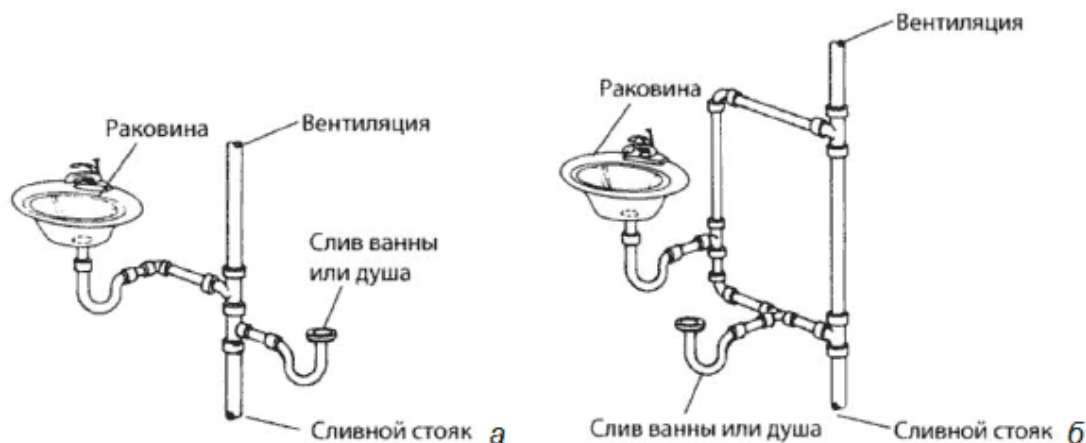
Многотрубные вентиляционные соединения. Прямые вентиляционные трубы подсоединяются напрямую к канализационному стояку и вентиляции (а). Деаэрация двух сливных труб, подсоединенных к стояку. Обратите внимание на кольцевое соединение труб, с помощью которого обе трубы подсоединены к вентиляции (б)
